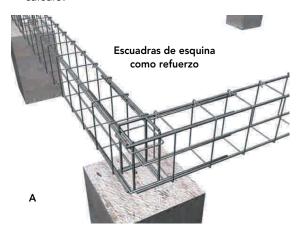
39 : Armadura de los cimientos de hormigón.
